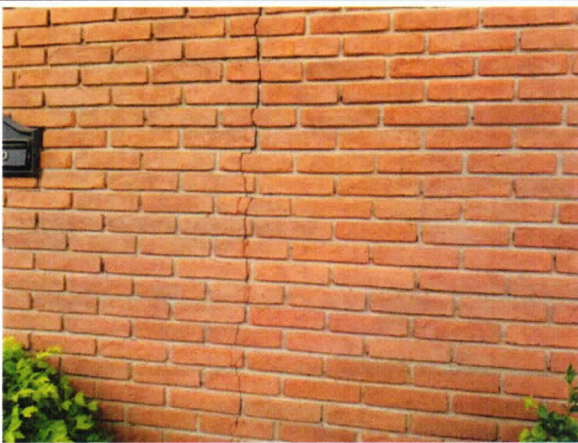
Vista da trinca vertical no muro com tijolos à vista.
